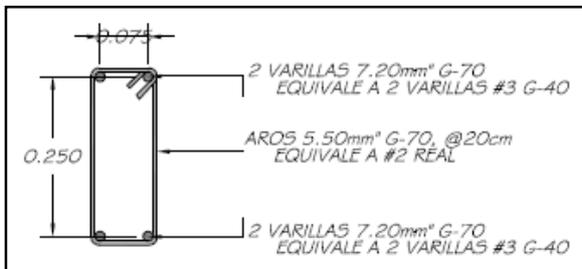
Detalle de la armadura de viga corona. Fuente: Manual para la construcción de edificaciones mediante el uso del sistema Modublock.
